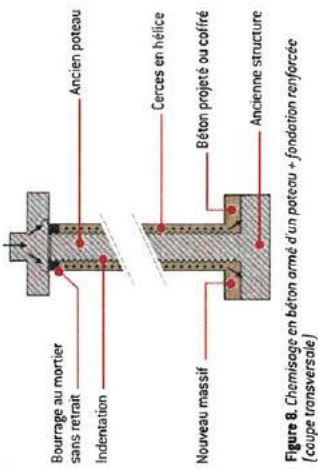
Chemisage en béton armé d'un poteau + fondation renforcée (coupe transversale)
